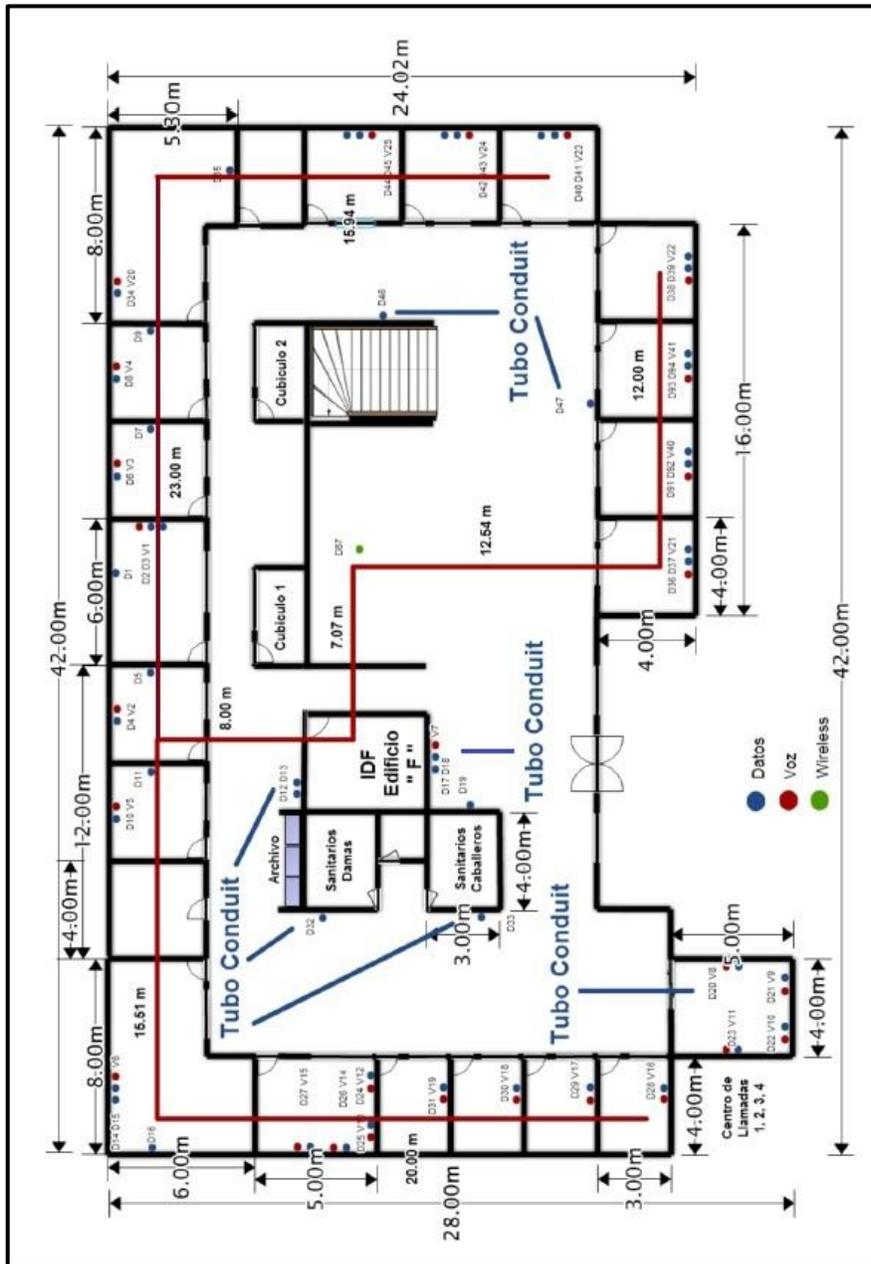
Ruta Cableado por escalerilla Planta Baja
